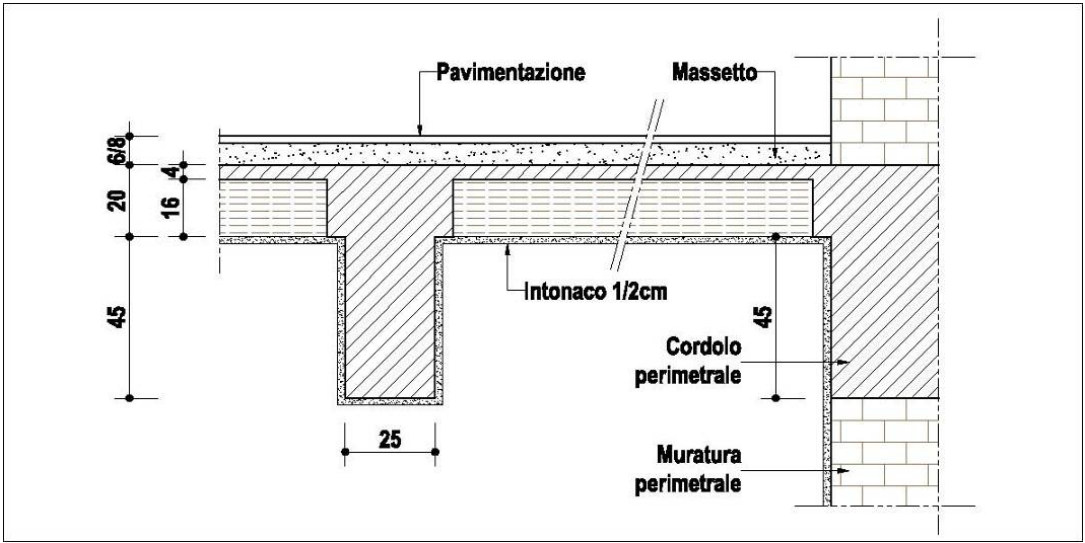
Solaio P. 1° – Ala nord – Massetto e solaio in latero-cemento
